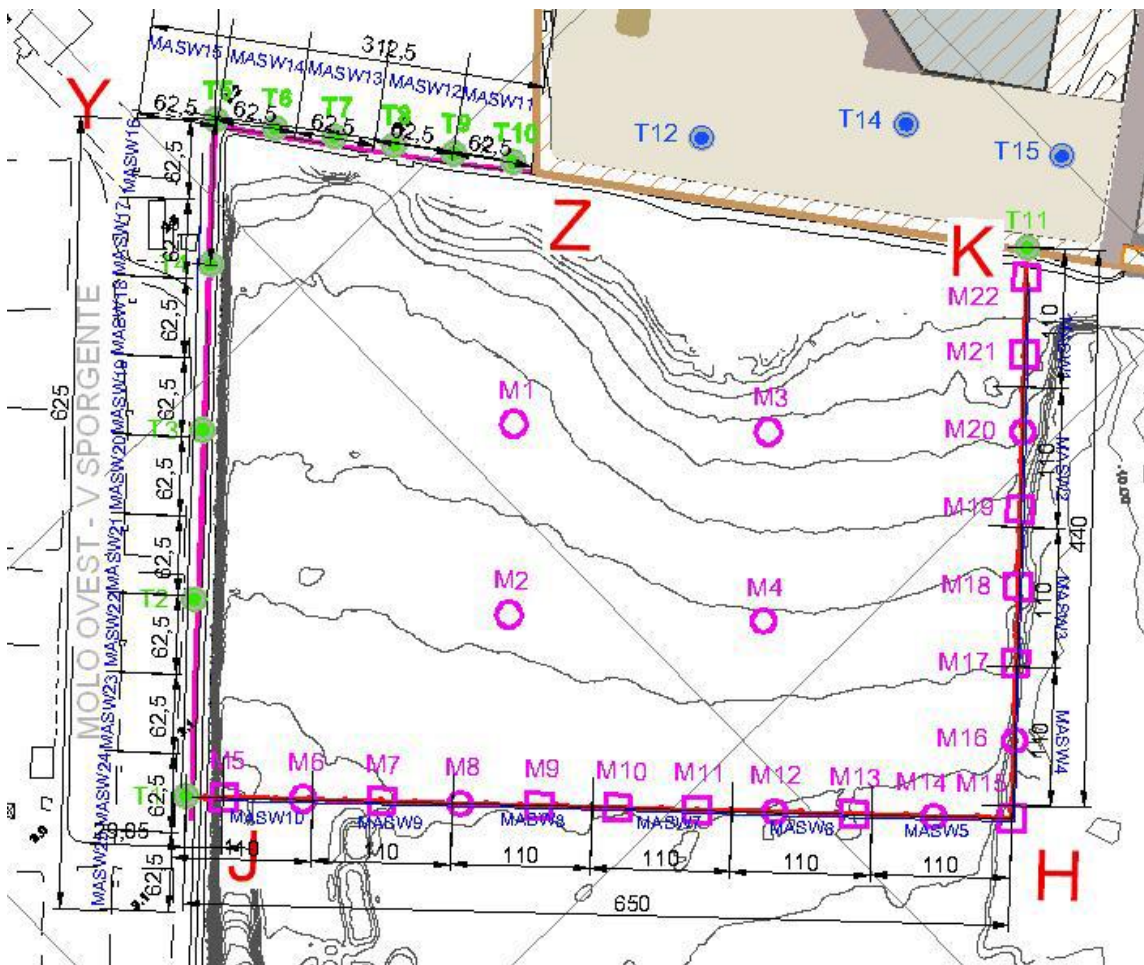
Stralcio planimetrico con ubicazione prove MASW
